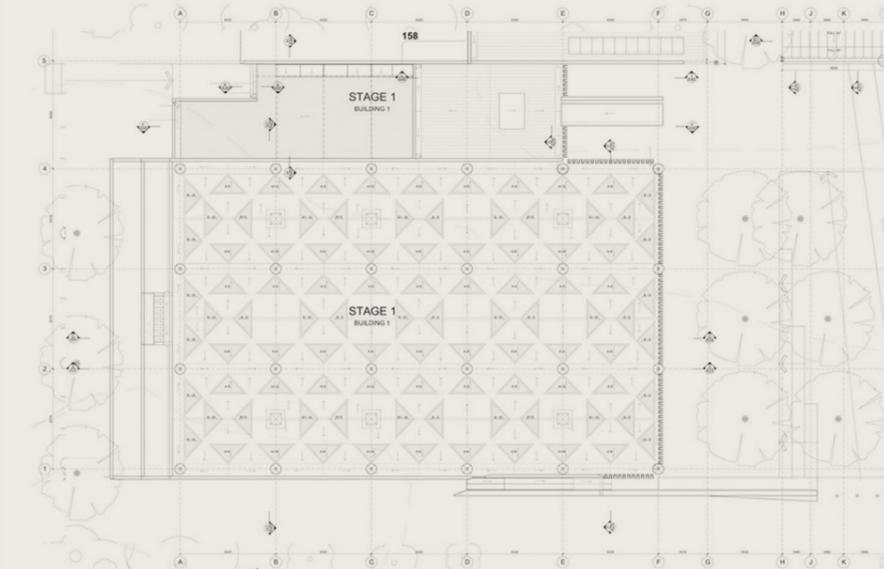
Planta de cobertura. Fonte: ArchDaily.
